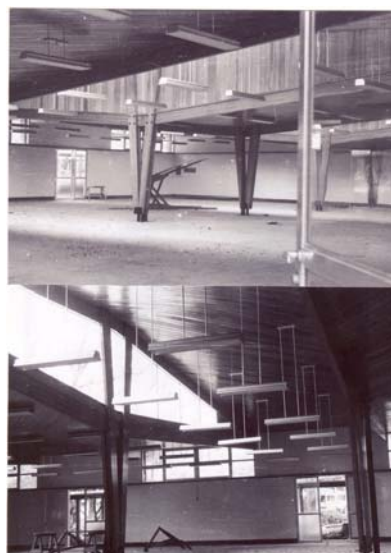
Construcción de los Talleres de Arquitectura en madera laminada-
